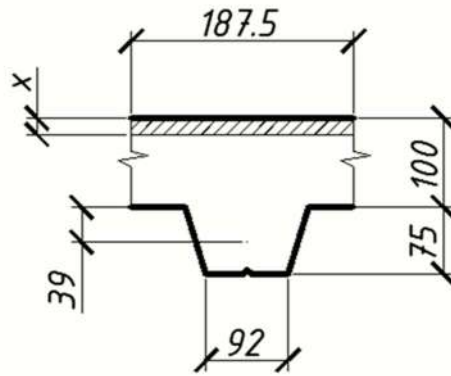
Расчетное сечение плиты перекрытия
